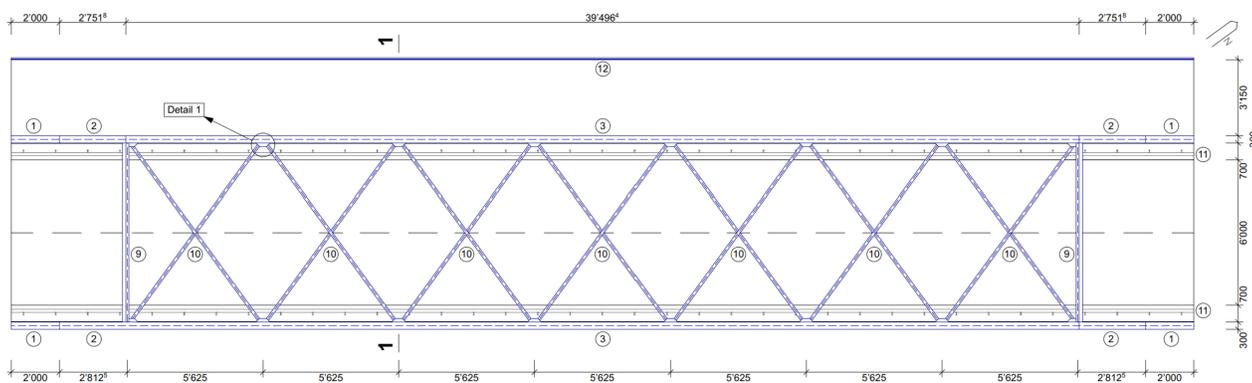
Grundriss — Fachwerkträgerbrücke
